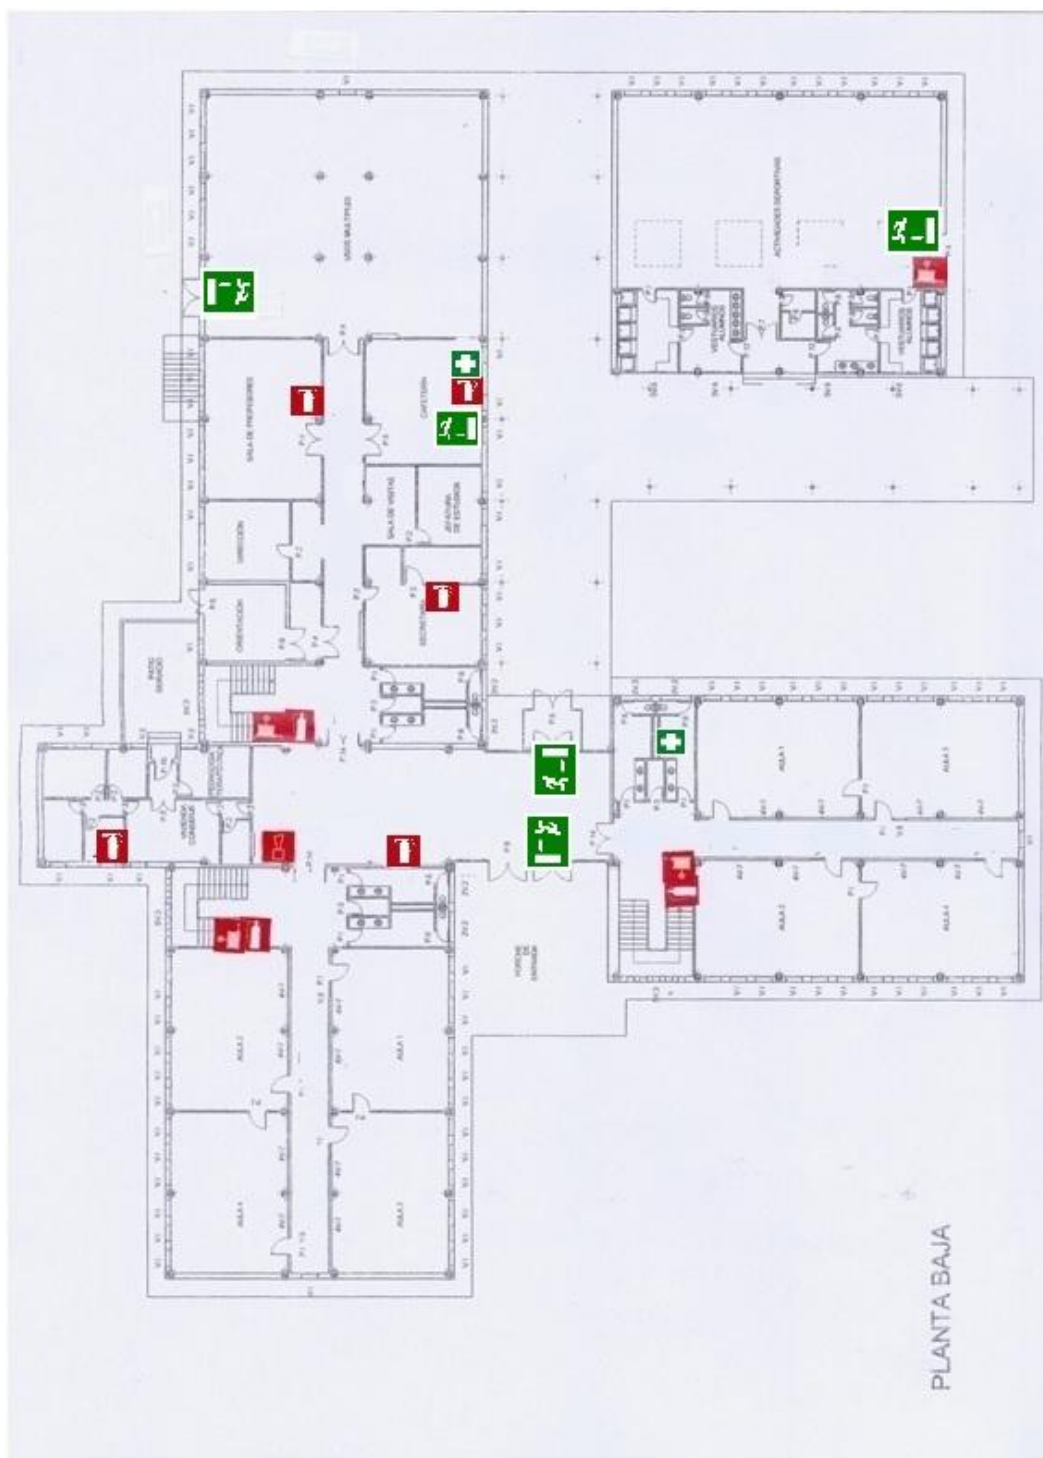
Plano planta baja I.E.S Cesar Manrique. Fuente: I.E.S Cesar Manrique.
